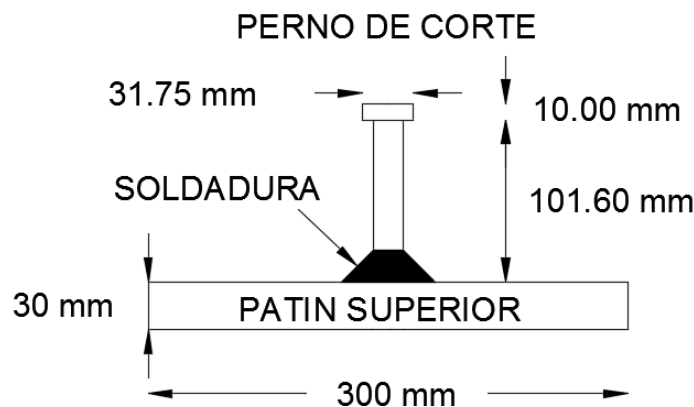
Cordón de soldadura entre el patín superior y el perno de corte Realizado por: Autor
